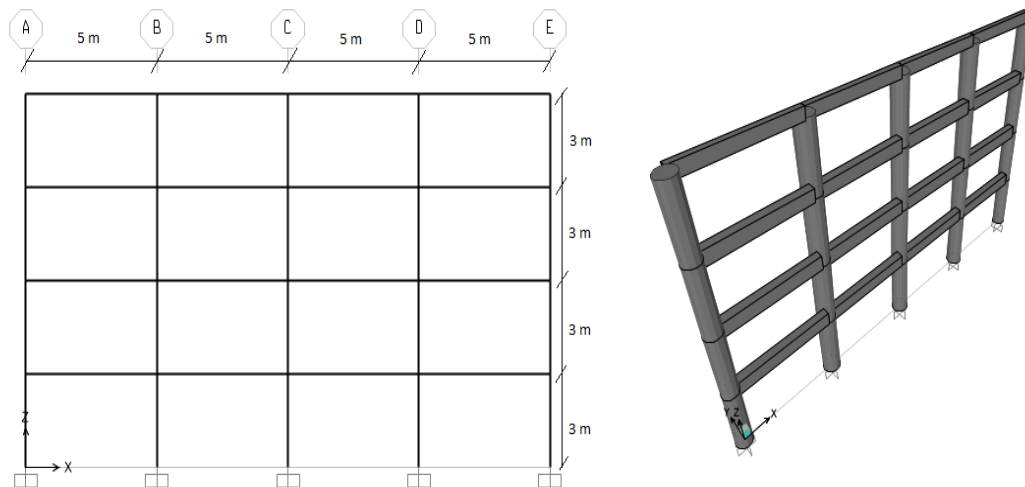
Pórtico patrón, inclinación de columnas 0° respecto al eje vertical.
